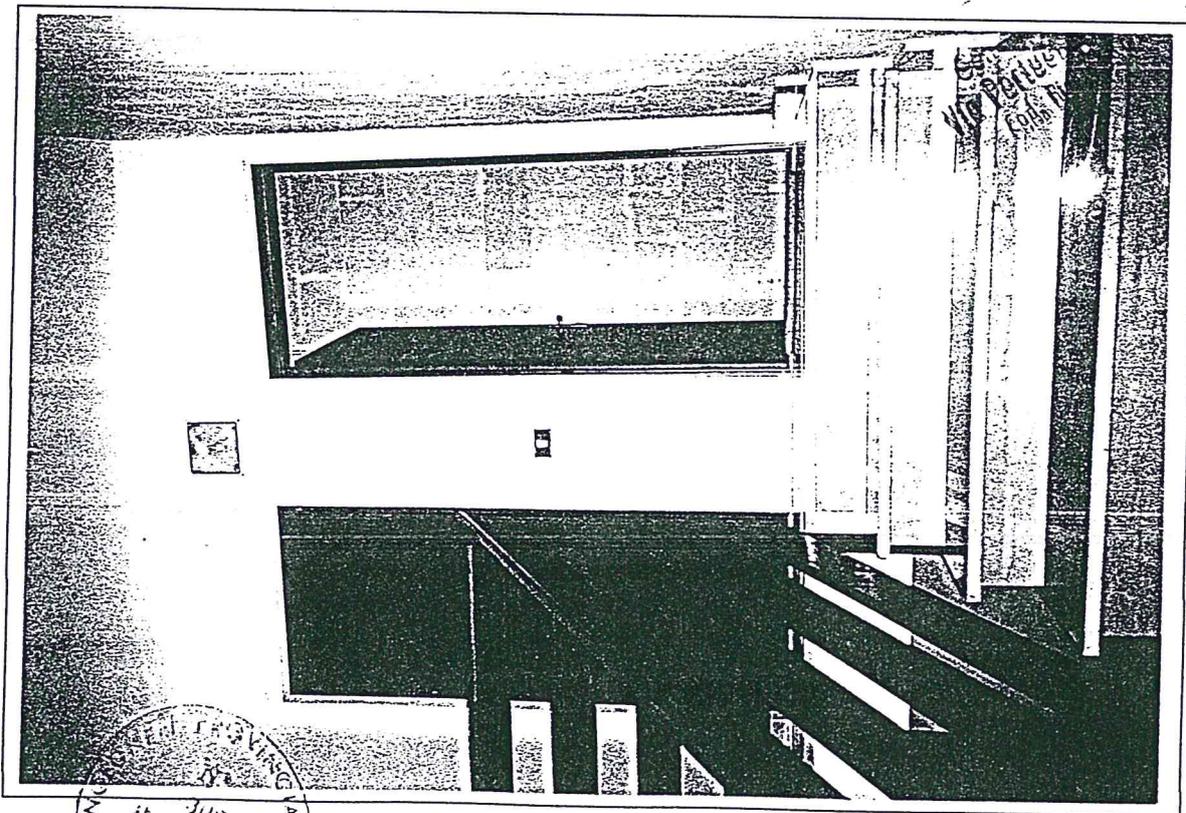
Porte di accesso ai sottotetti. Il dettaglio è tipico per tutti i vani scala.
